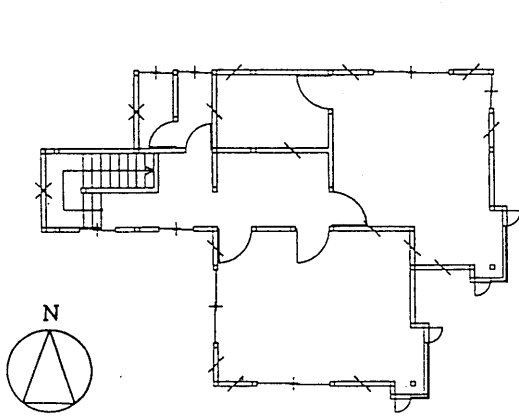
解析対象建築物平面図 (No.5, No.6)
